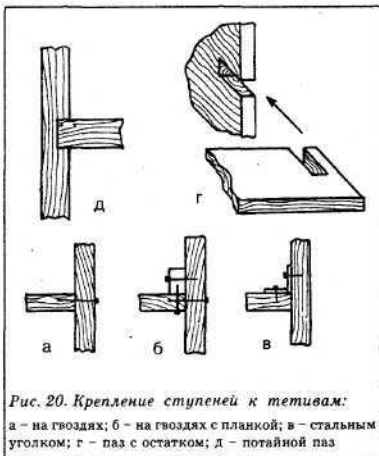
Крепление ступеней к тетивам: а – на гвоздях; б – на гвоздях с планкой; в – стальным уголком; г – паз с остатком; д – потайной паз
